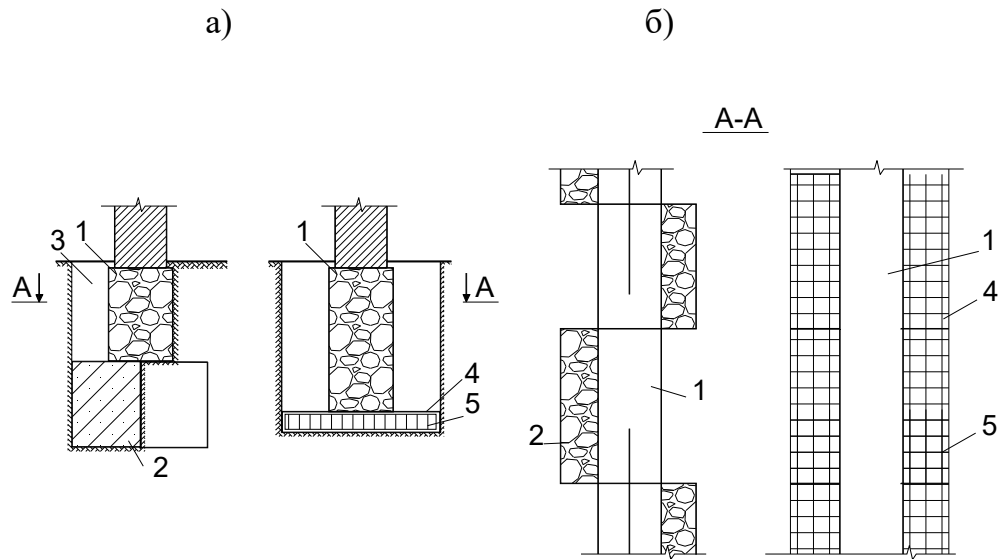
Конструктивні рішення підводки фундаменту:
